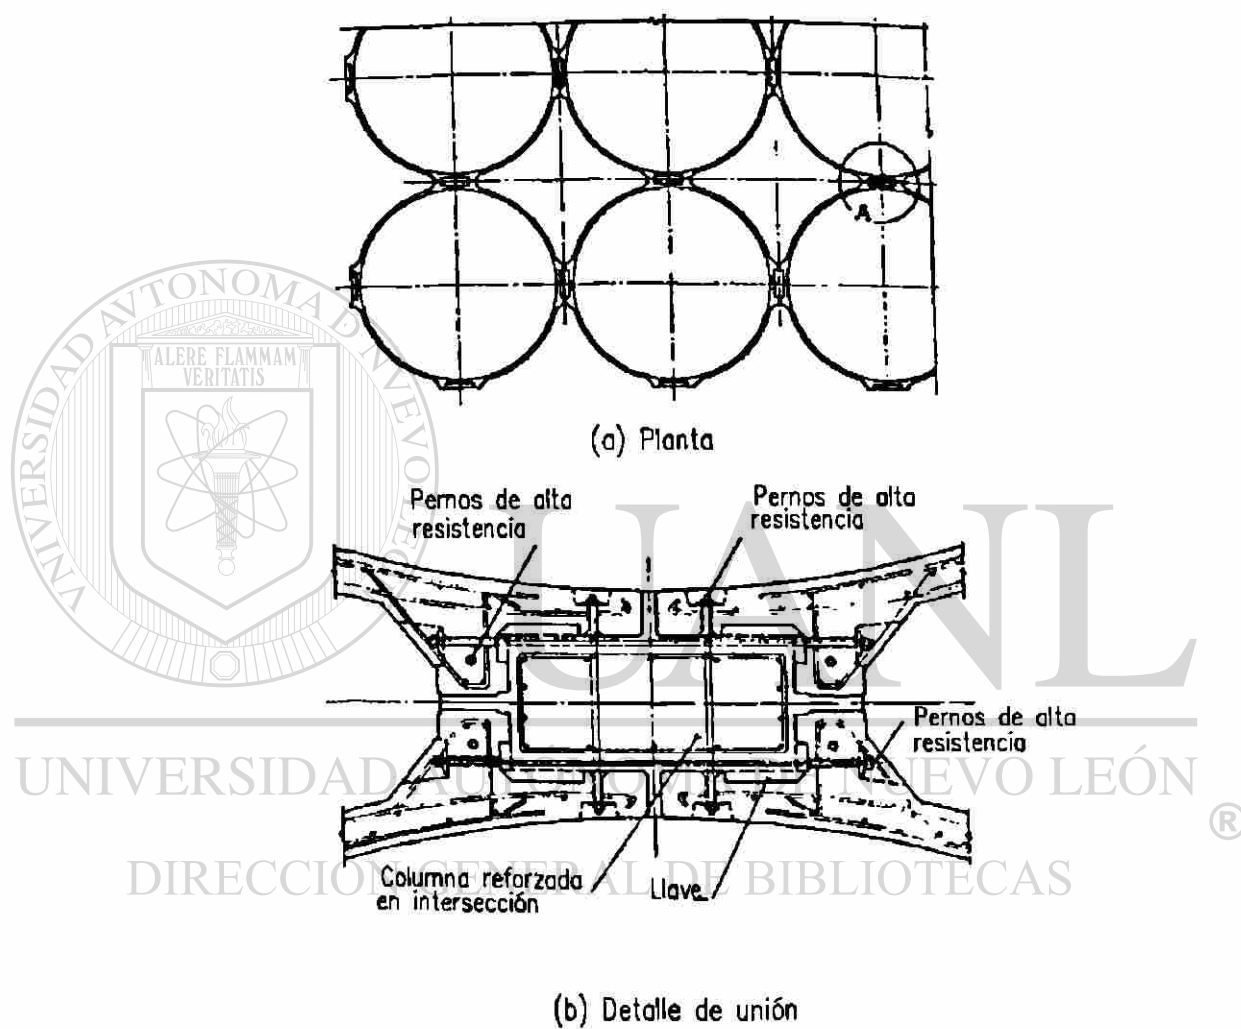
Silos precolados. Planta y detalles de conexión.
